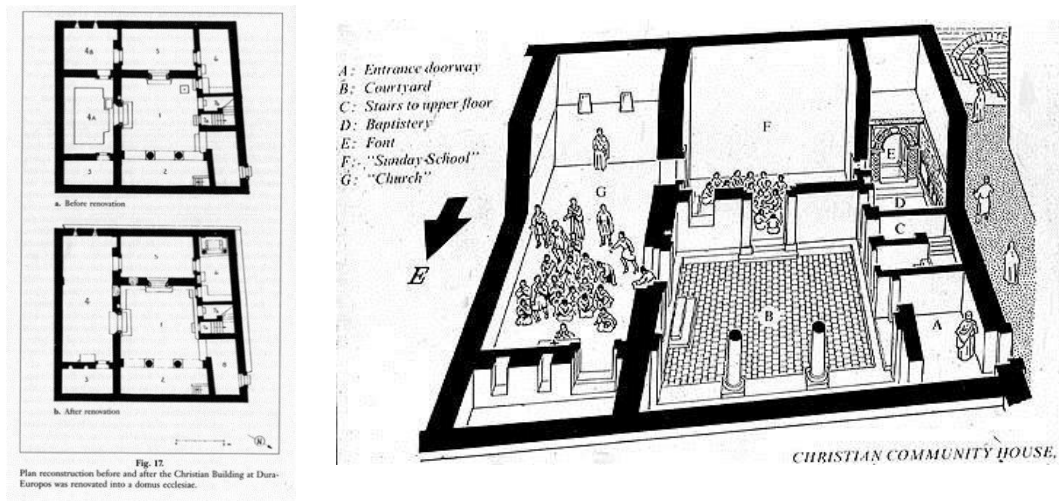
u 22: Dura Europos, links: Grundrisse, rechts: Gebäudeschnitt (Rekonstruktion)
